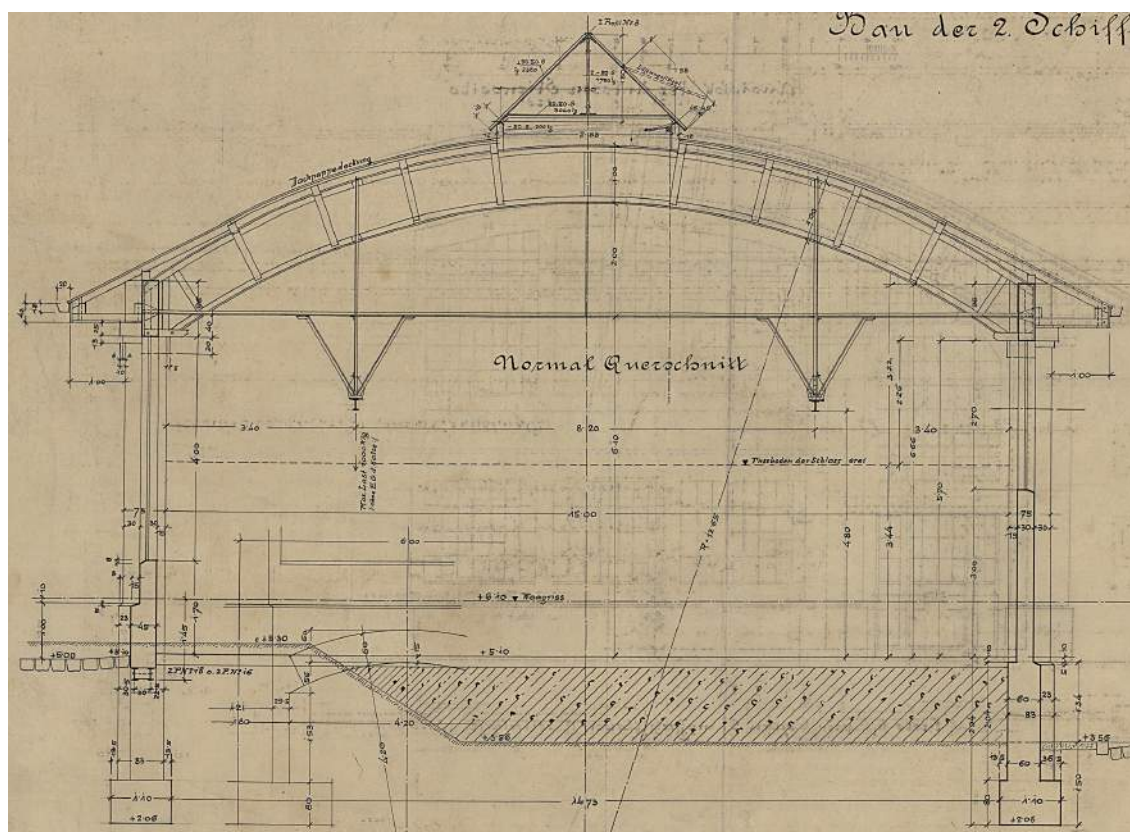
Querschnitt durch die geplante Schiffsbauhalle 83
